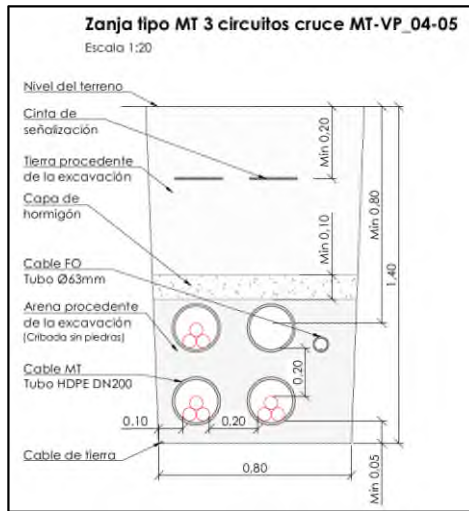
Sección tipo de la zanja para cruces de MT entre las islas 11 y 07 con Vía Pecuaría
